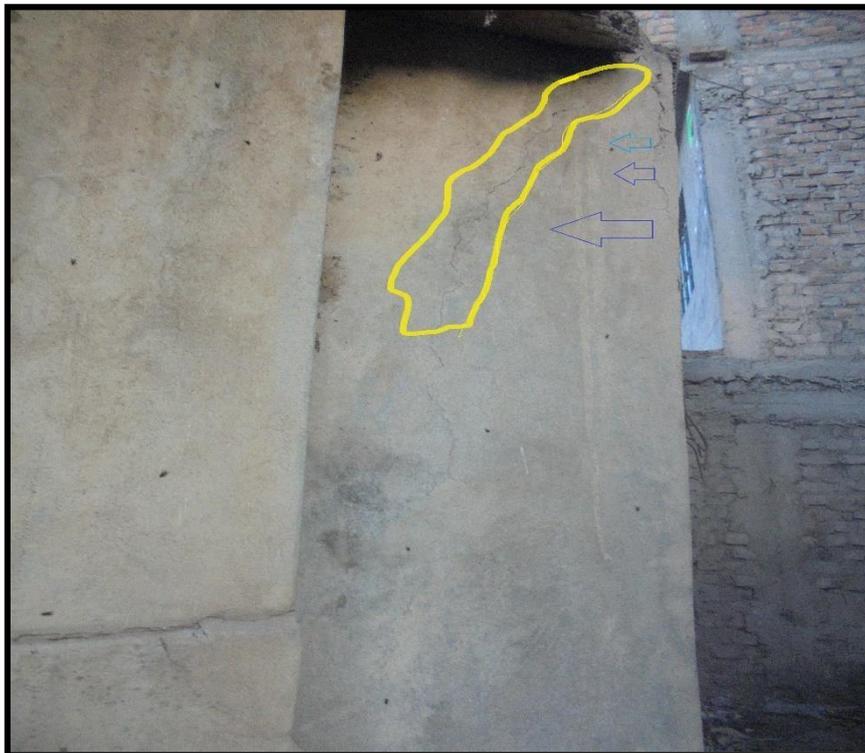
LAS FISURAS EN LA VIGA
